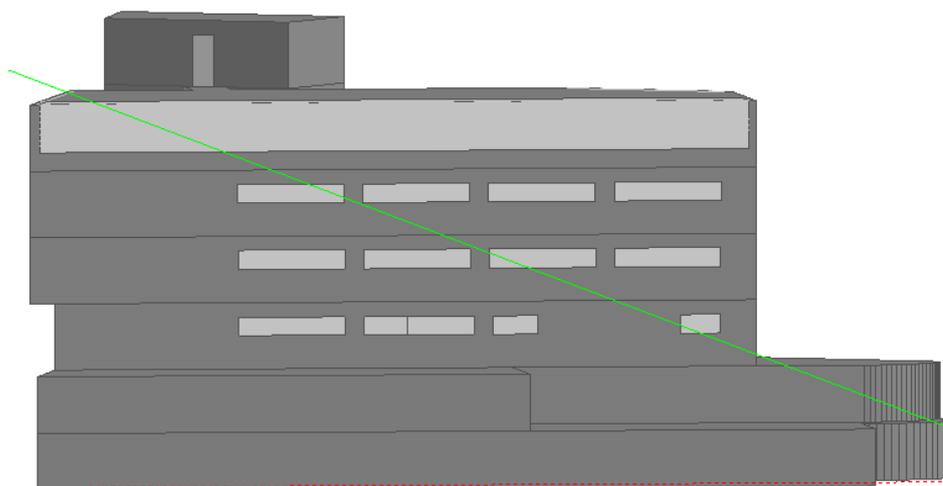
Localização dos painéis fotovoltaicos na fachada este.
